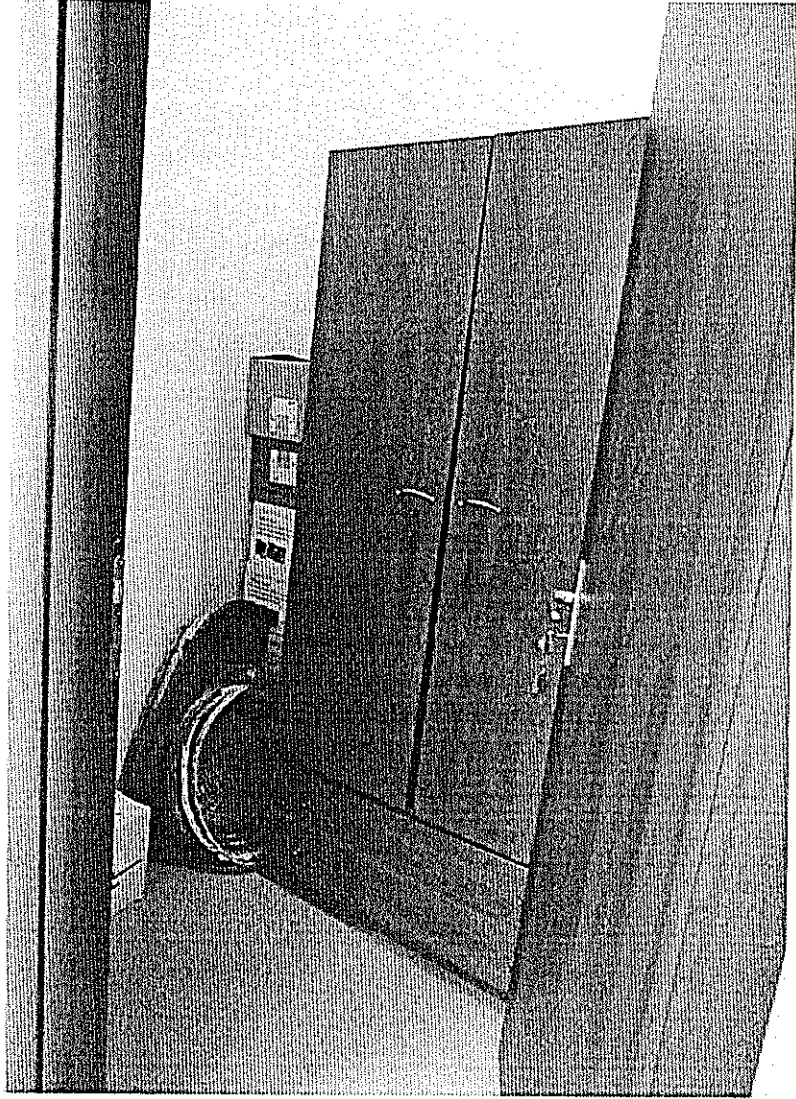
Deposito nell'ala nord del primo corpo di fabbrica – piano primo.
